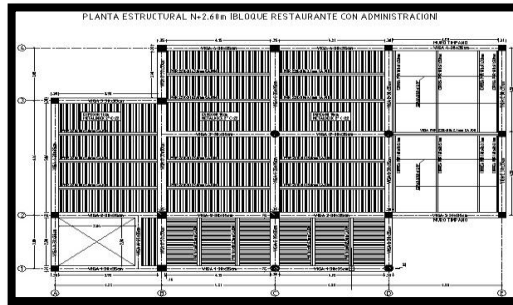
Planta estructural N + 2.60 del Bloque de restaurante.
